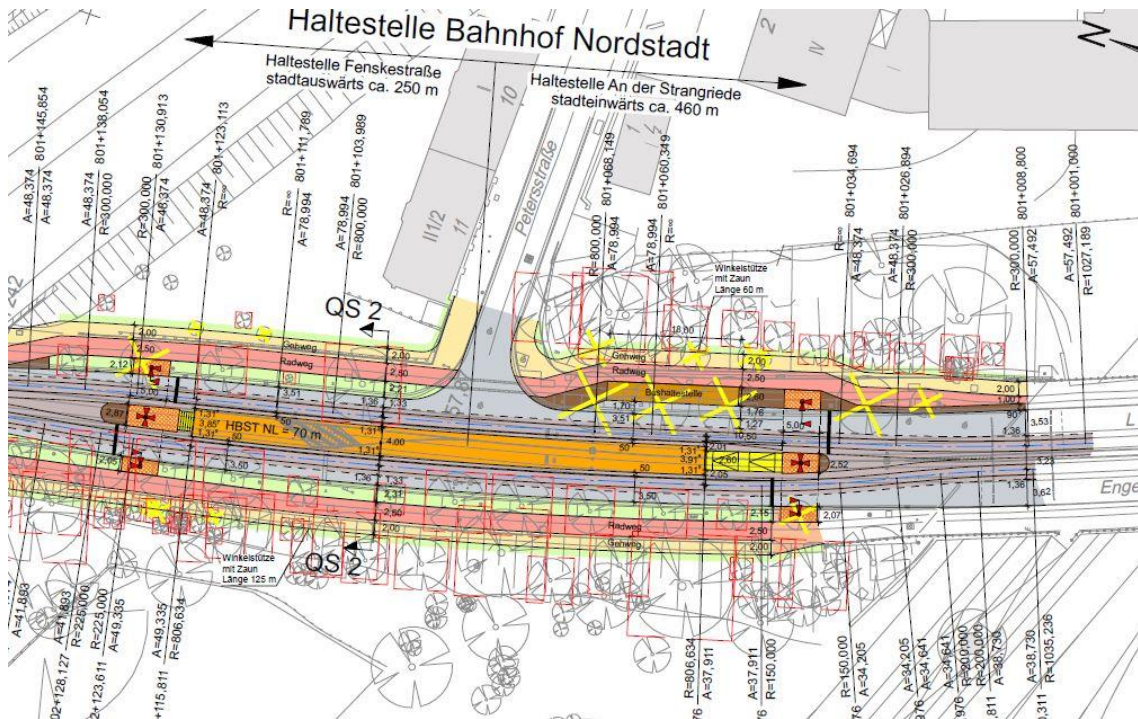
Südausschnitt aus dem Lageplan Varianten 8a/8b, V8a\_VA0LA1
